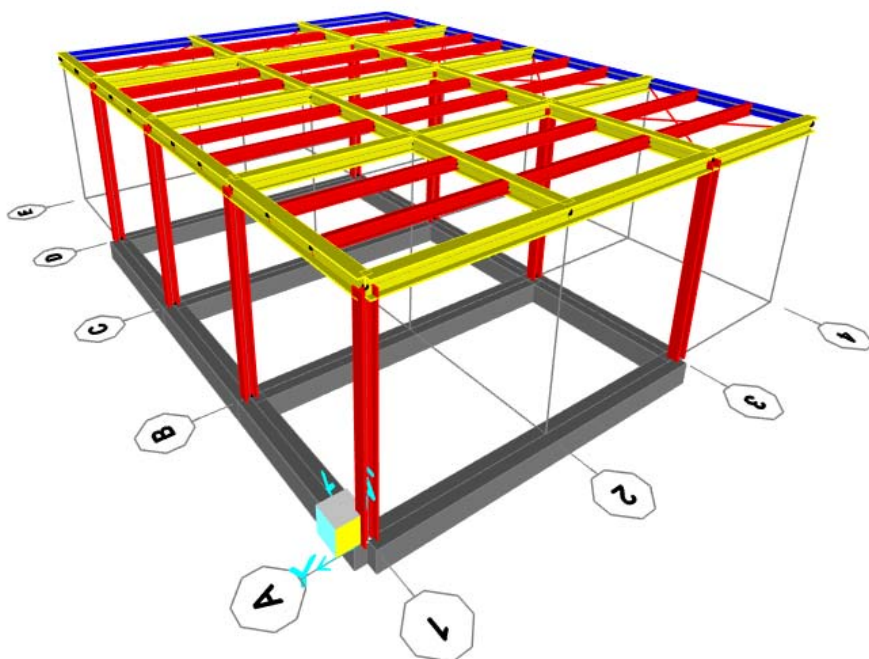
Vista assonometrica modello struttura elevazione/fondazione
